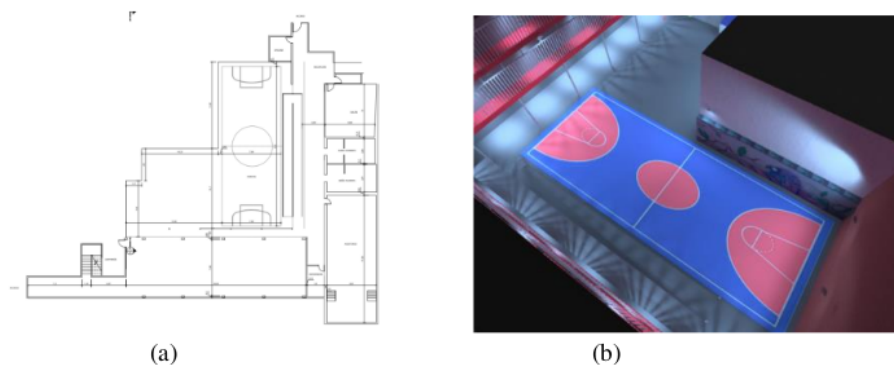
Planos arquitectónicos (a) 2D Planta 1 (b) 3D centrado en la cancha.
